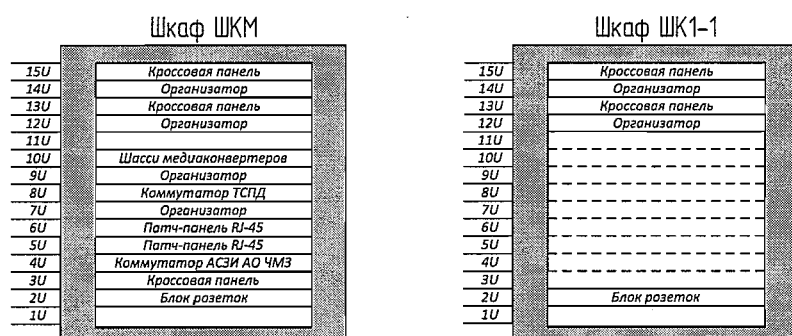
Корпус 702. Шкафы ШКМ (существующий) и ШК1-1(вновь установленный). Расположение оборудования.
